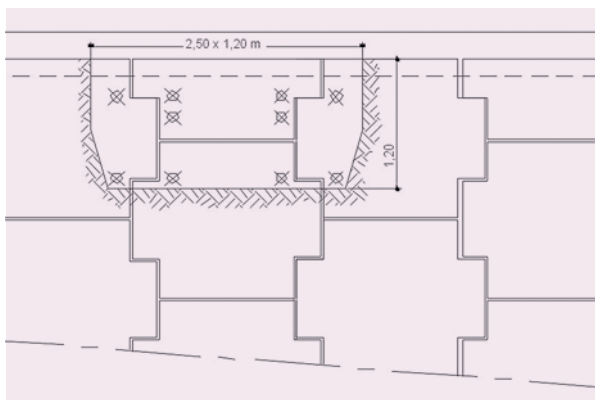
exemple d'implantation (élévation) d'une petite fouille avec repérage des armatures dégagées
